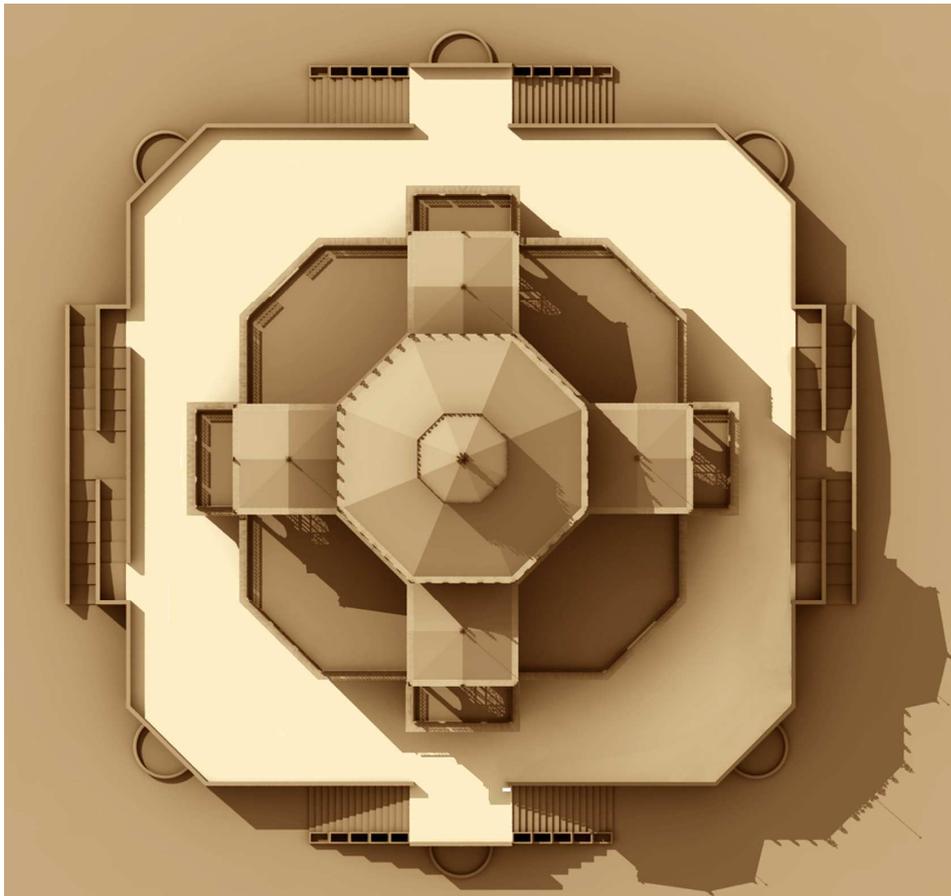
Pianta delle coperture (modellazione: Silvio Messina, rendering e post-elaborazione grafica dell'autore).
